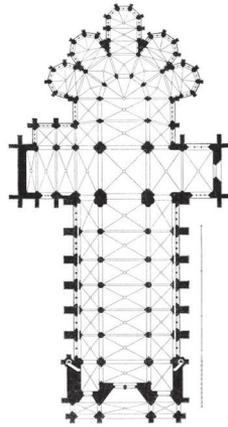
Собор Нотр-Дам в Се. План. Фасад – 1240-е гг.
